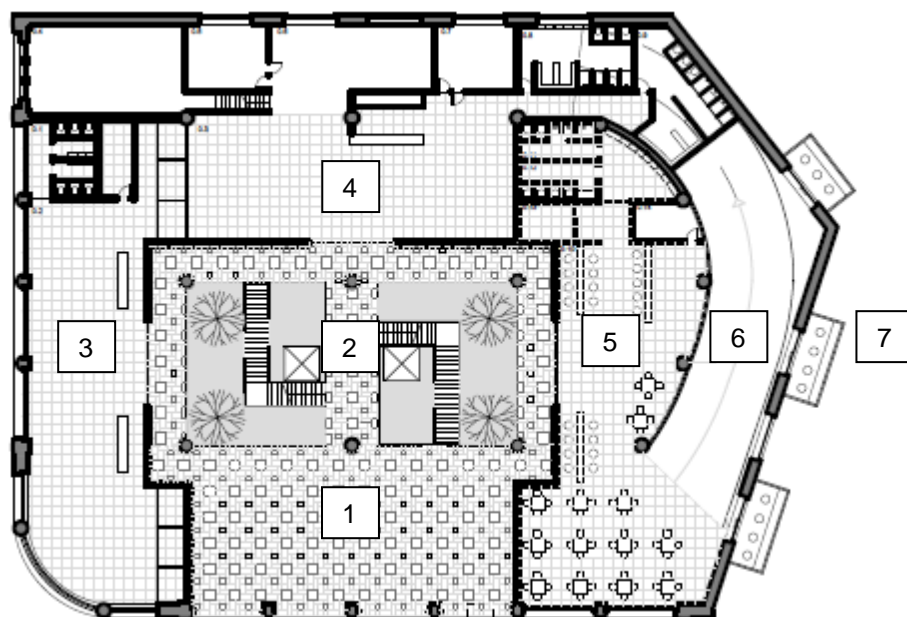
Piso 0 Proposta - Entrada, Serviços e Restauração, escala 1/500 (Autora,2019)
